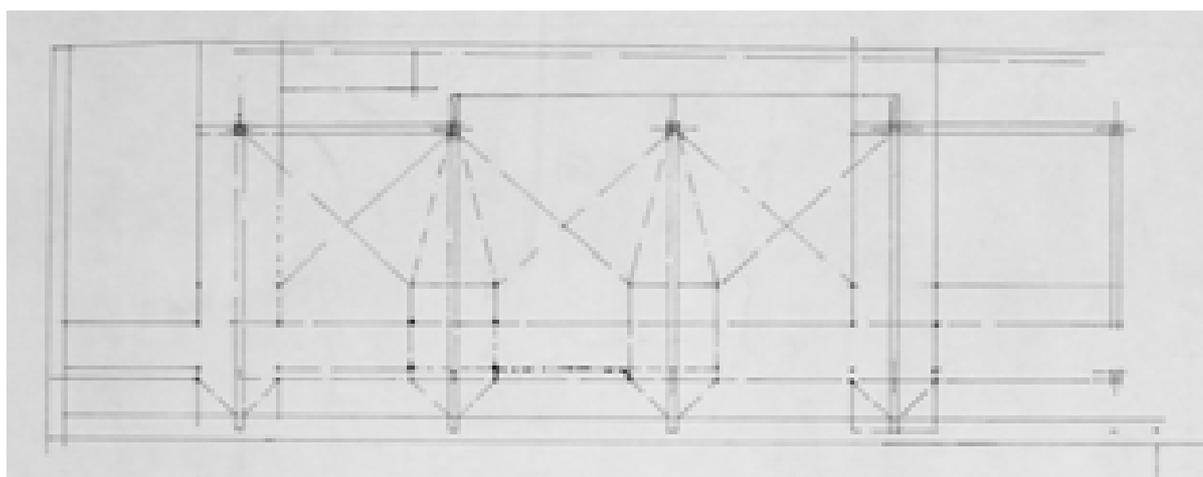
Studio planimetria, lucido – s.d. (AABS-95.093)
